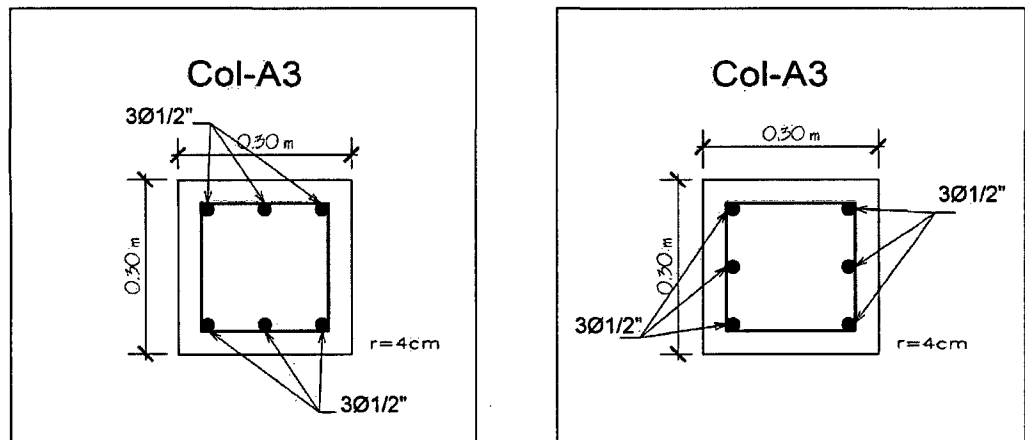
Distribución de refuerzo en cada uno de los lados de la columna A3.
